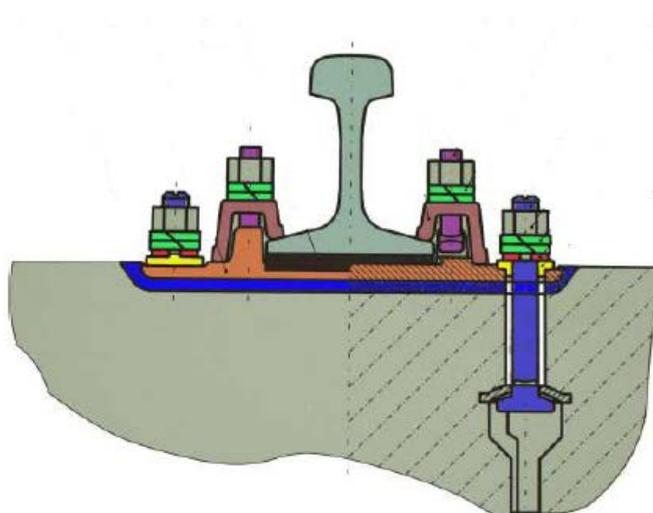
Жесткое раздельное рельсовое крепление для железобетонных шпал
